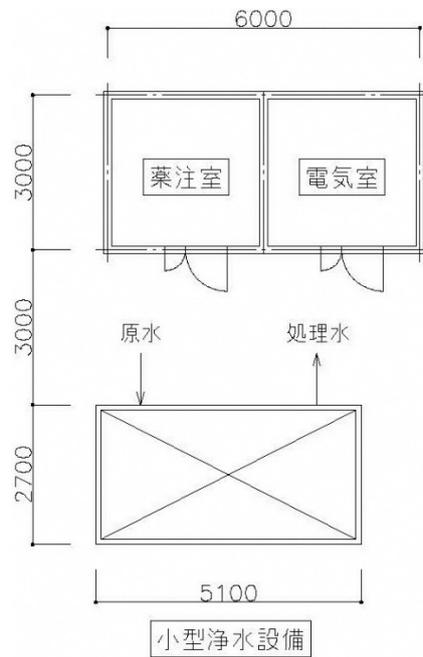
平面配置図 (凝集沈澱+急速ろ過)
